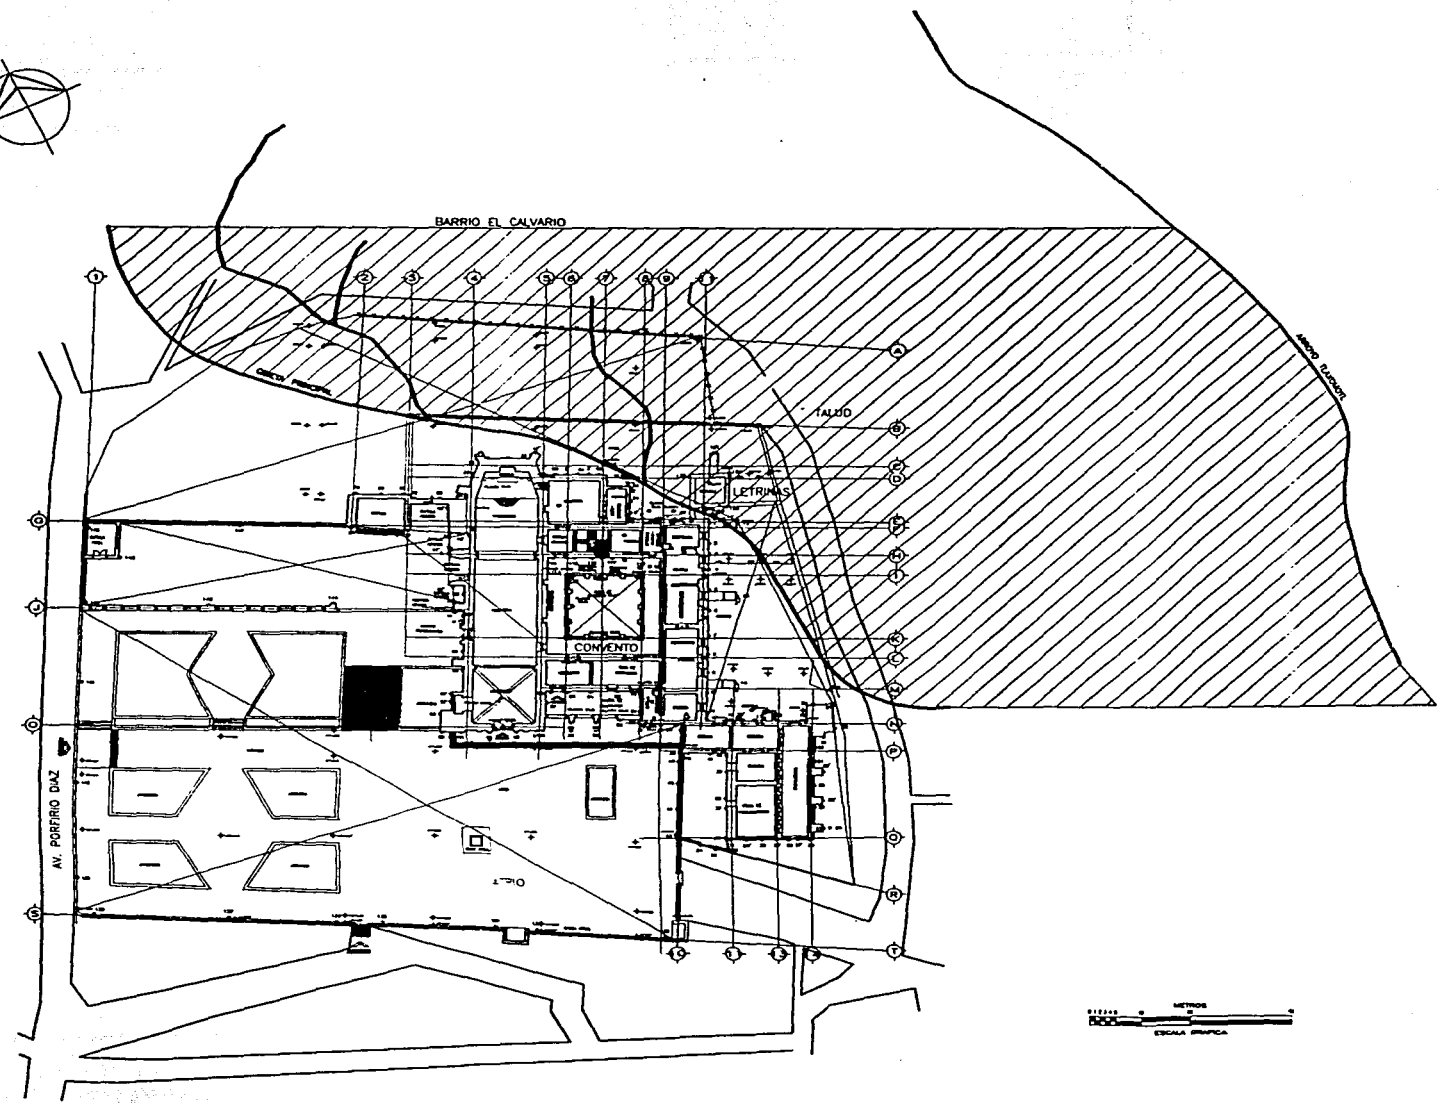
LOCALIZACION EN PLANTA DE LA ZONA AFECTADA POR EL DESLIZAMIENTO DE LA LADERA.
